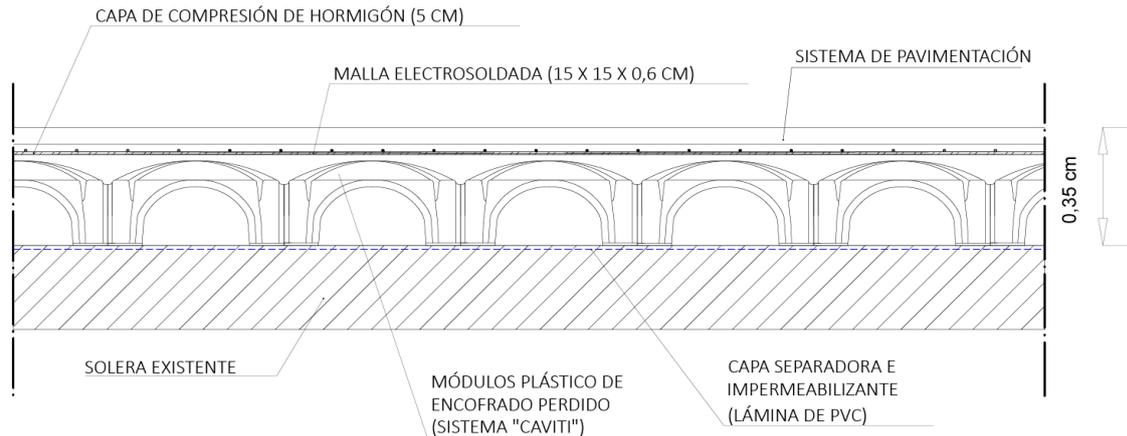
Detalle forjado ventilado mediante sistema modular de encofrado perdido. Fuente: elaboración propia
